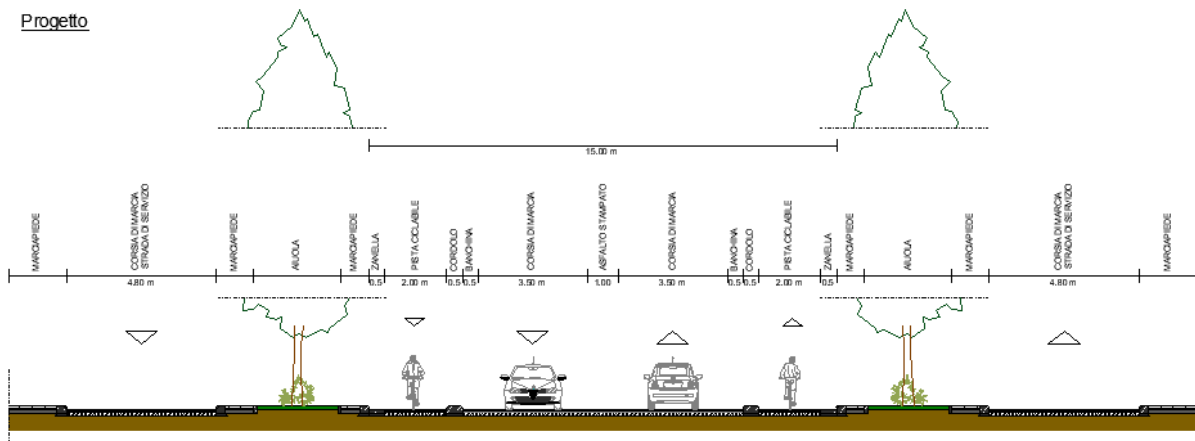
viale Traiano, sezione trasversale di progetto.
